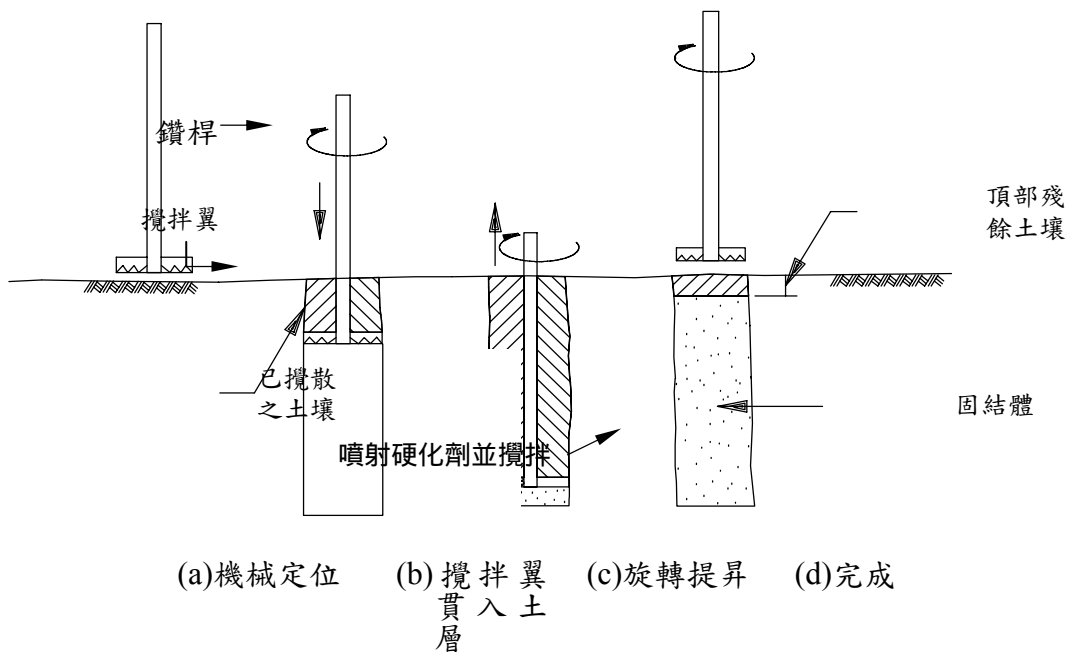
機械攪拌工法施工順序示意圖
